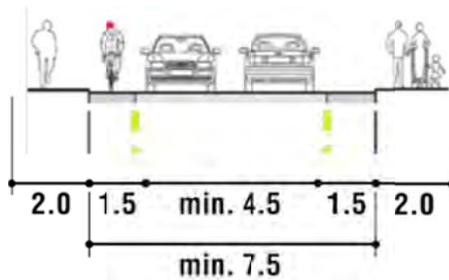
Profil-type d'une chaussée à voie centrale banalisée
